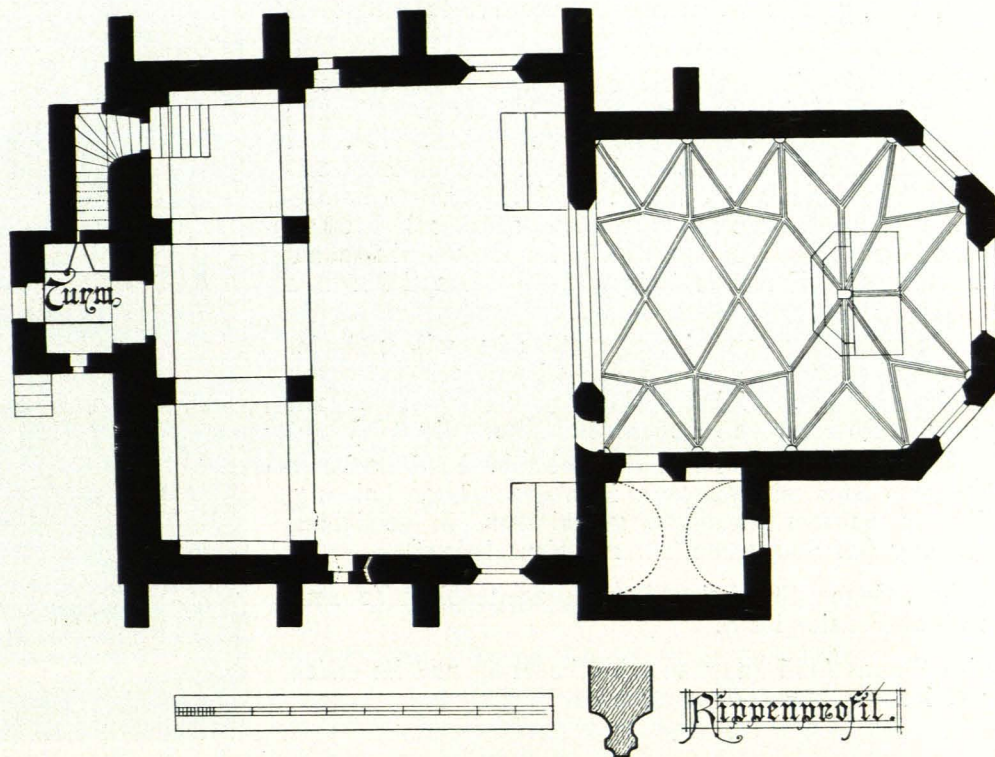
Pöbring, Pfarrkirche, Grundriß 1:200 (S. 154)
